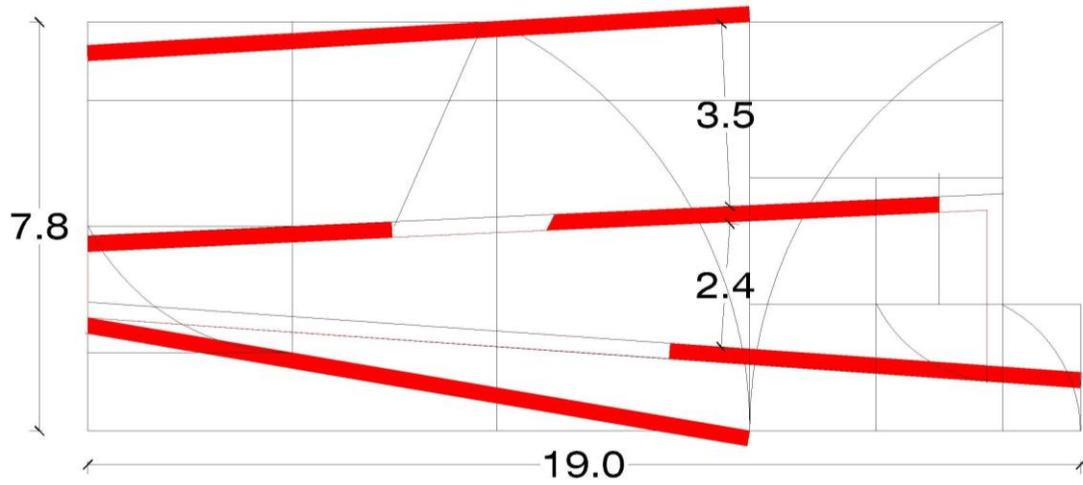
Esquema en planta de una vivienda tipo con medidas generales.
